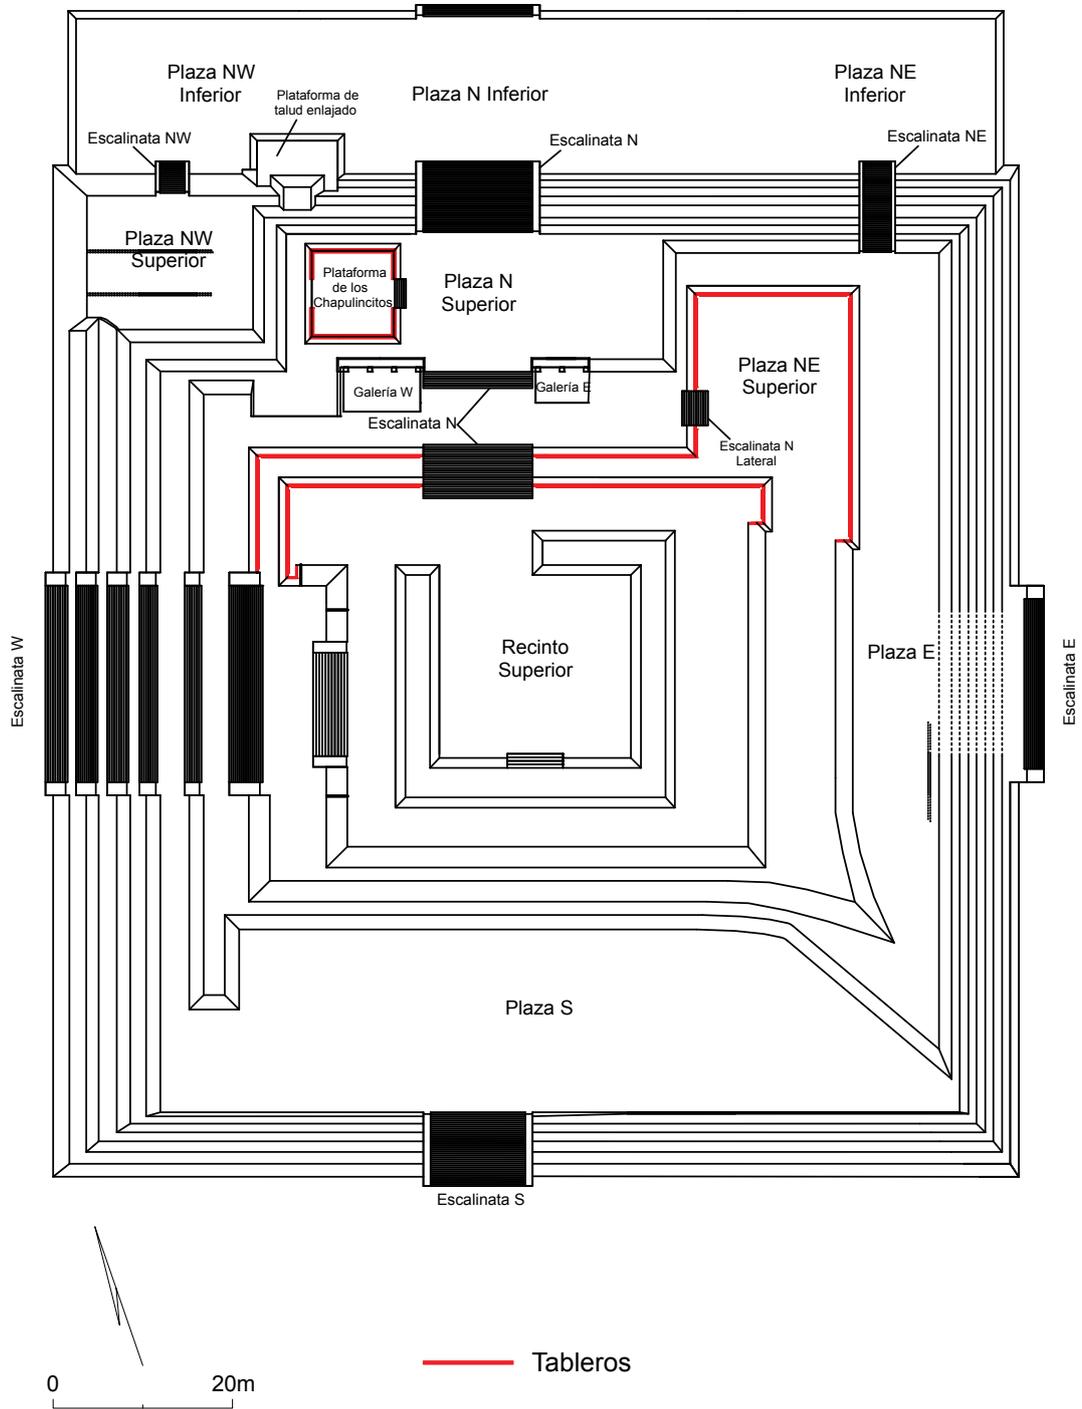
Plano reconstructivo del Edificio de los Chapulines, con denominación de elementos constructivos.
